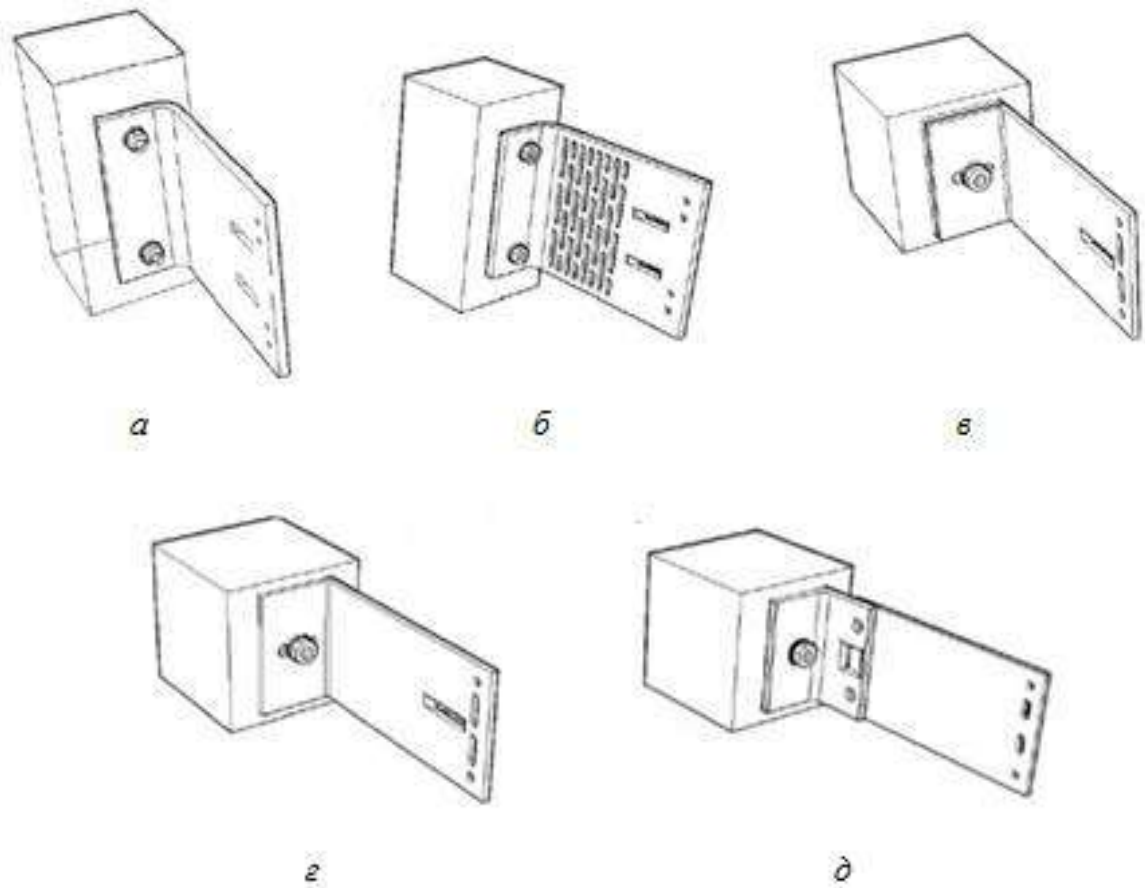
Конструкції кронштейнів для монтажу вентилязованих фасадів
